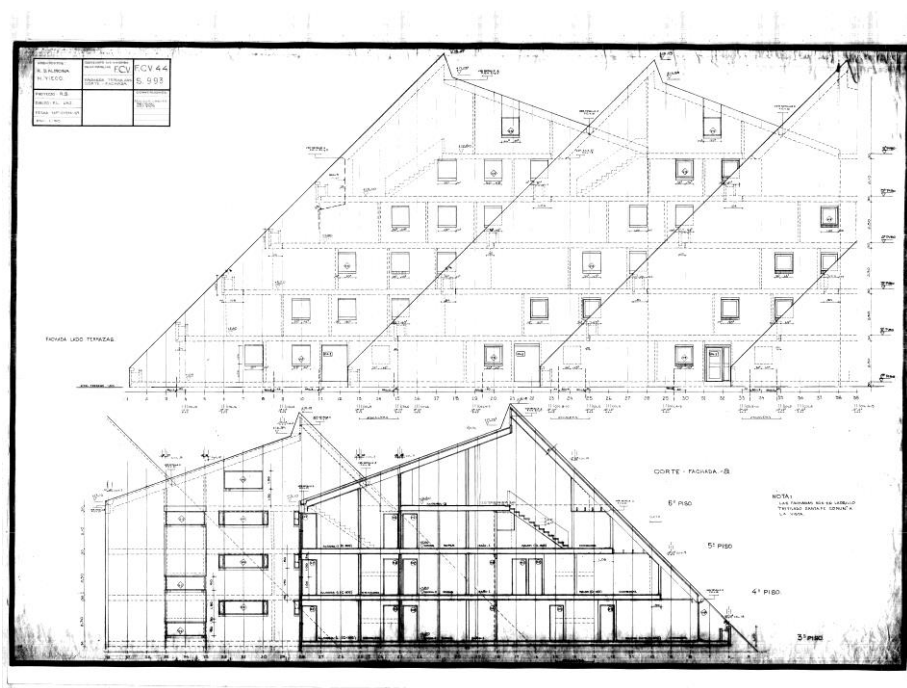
Fundación Cristiana de la Vivienda, alzado y sección parcial.
